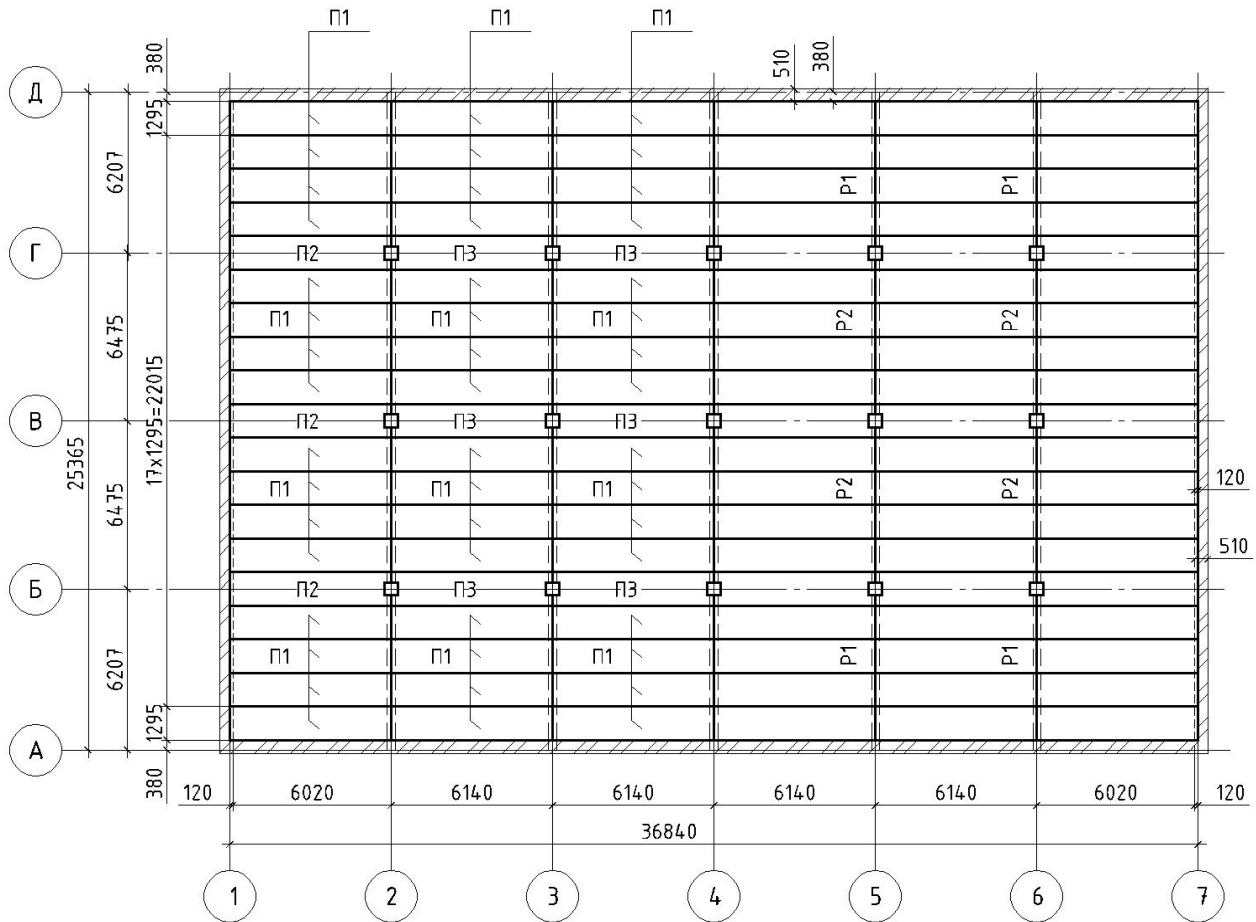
Схема расположения сборного железобетонного перекрытия на отм. +4.150, +8.350 и +12.550
